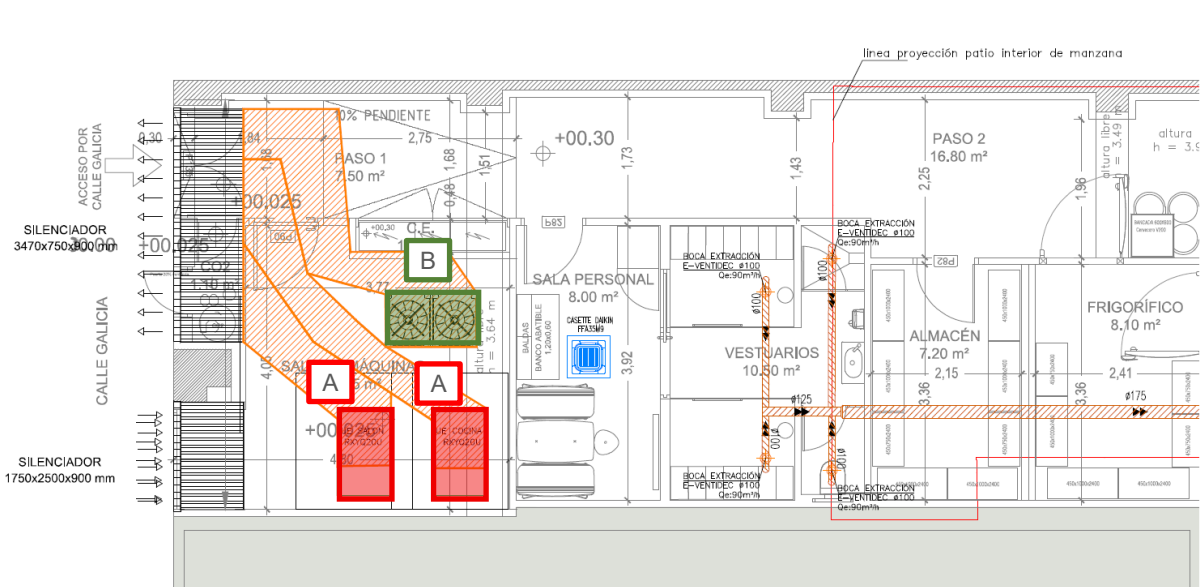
Medidas correctoras de maquinaria Planta Baja. Local - Calle Belchite 2, Logroño.
